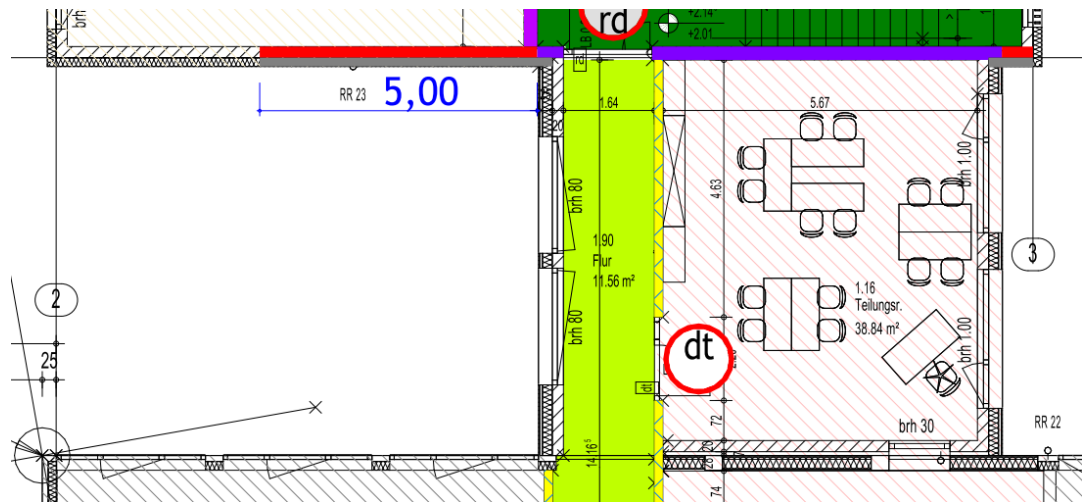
Ausschnitt Grundriss OG1/ Achse A-B/2-3
